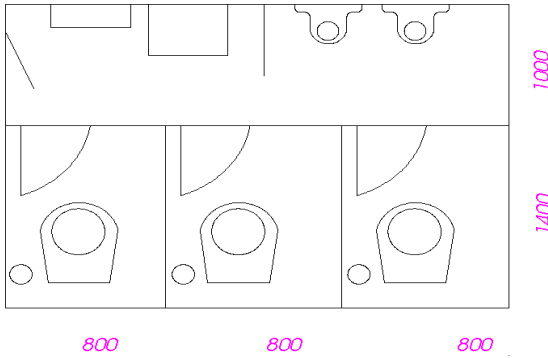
b Hệ thống buồng vệ sinh công cộng
